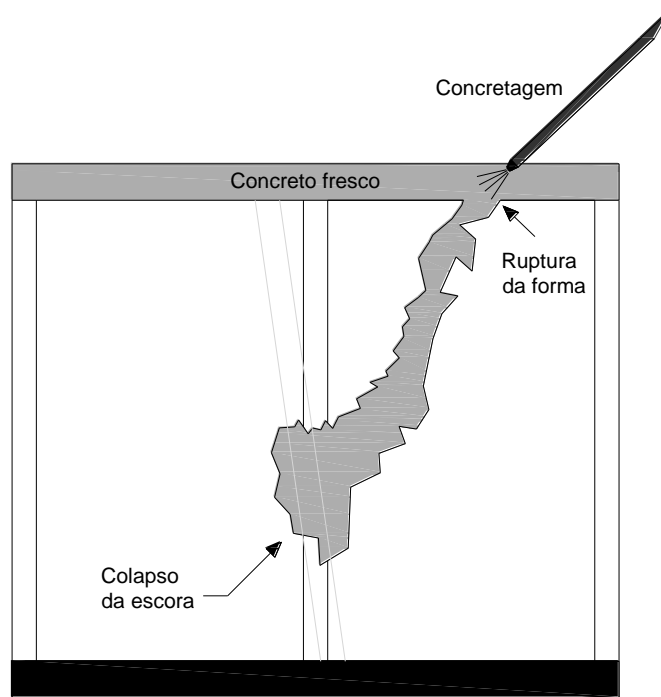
Colapso provocado por ruptura da forma, CUNHA (1998)
